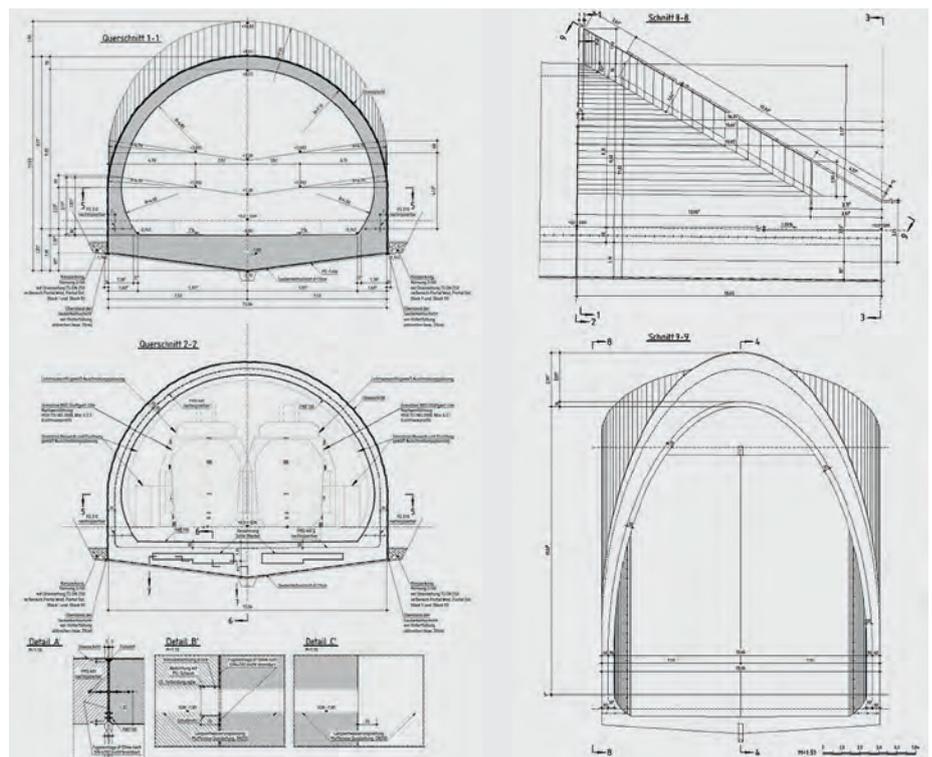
Konstruktion der Portale Tunnel Widderstall
